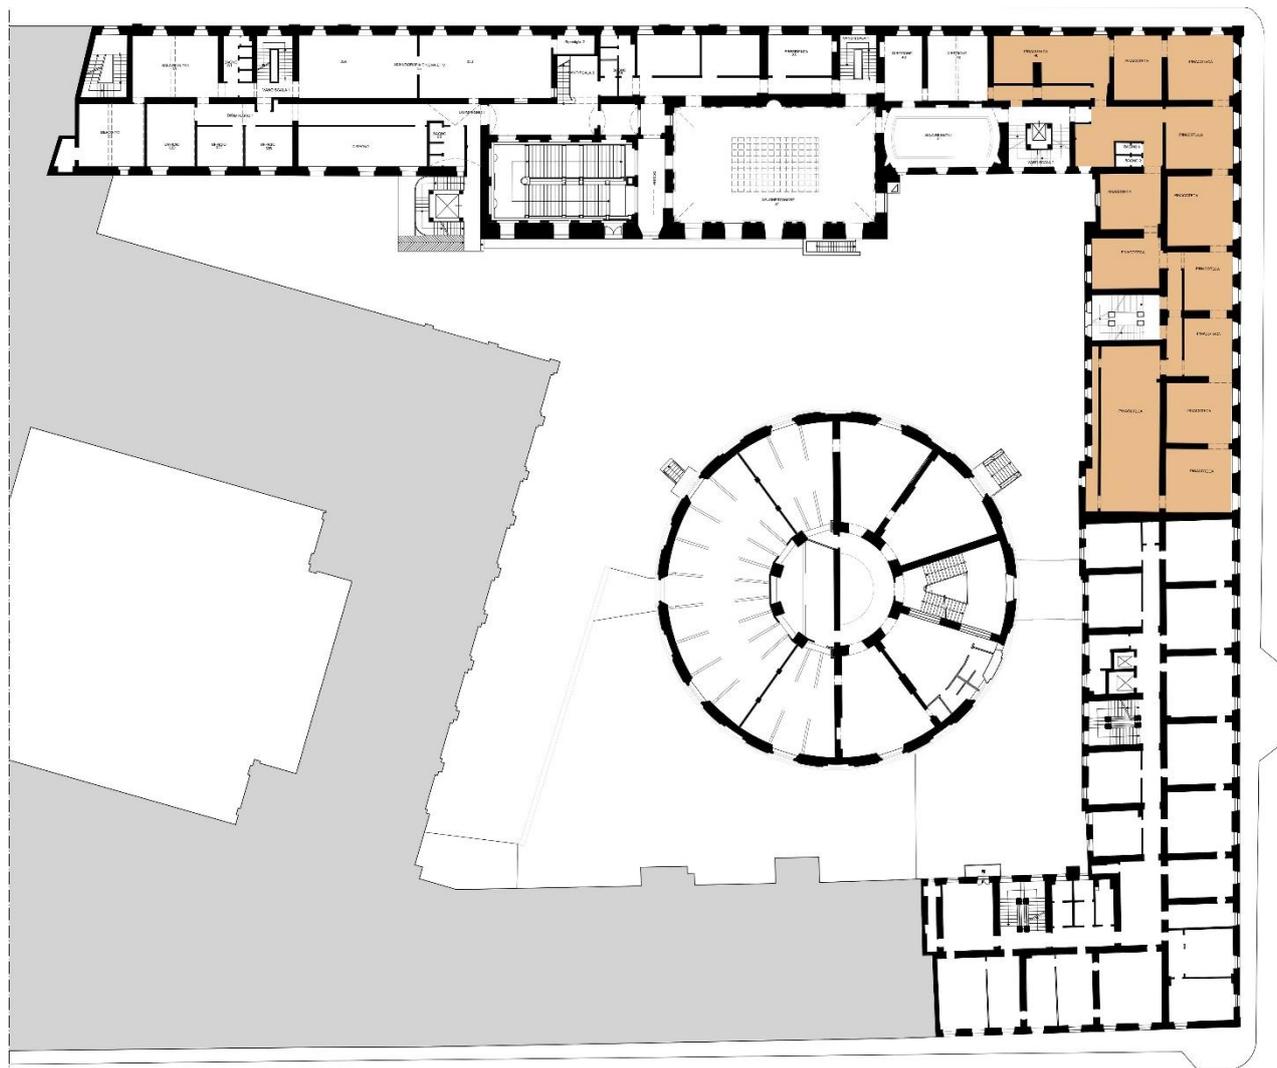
Pianta dello stato di fatto con indicazione dei locali riservati alla Pinacoteca Albertina, secondo piano.
